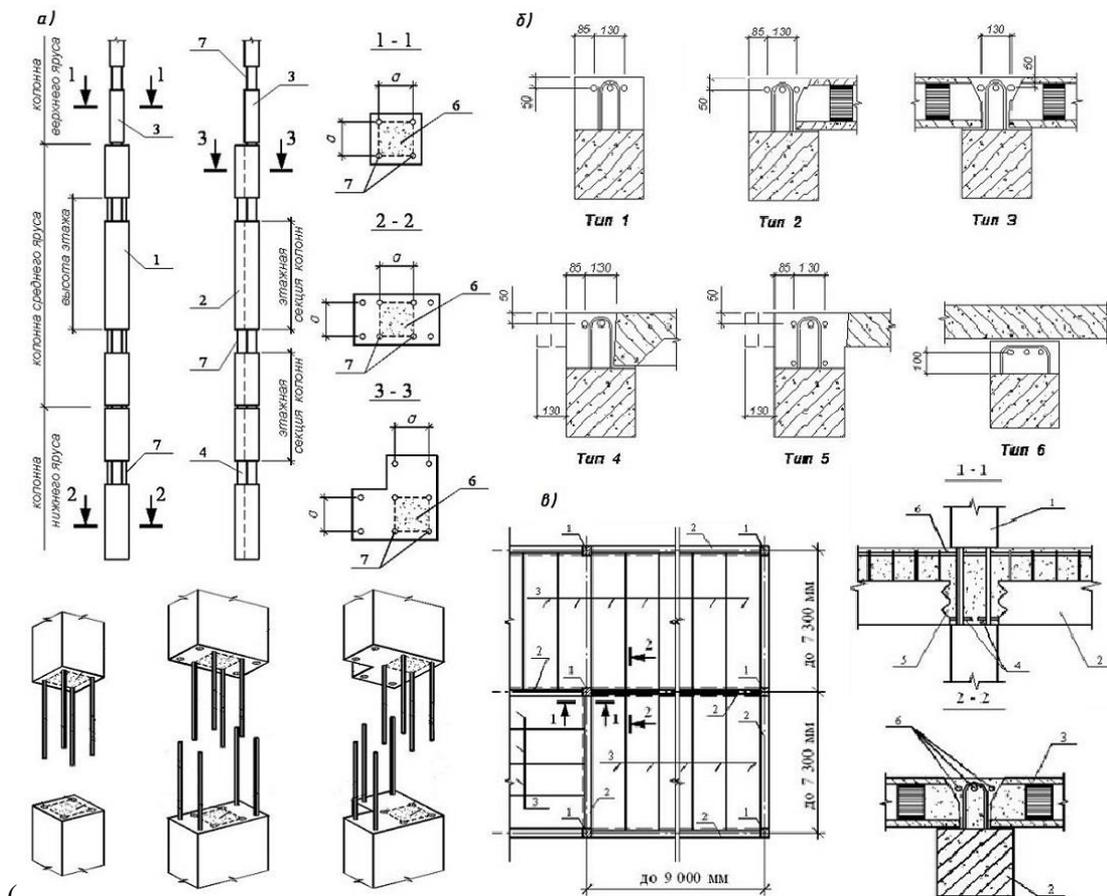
, в). Для обеспечения пространственной жесткости в пролетах между колоннами на всю высоту здания устанавливаются диафрагмы жесткости, которые соединяются с колоннами через монолитный ригель.
